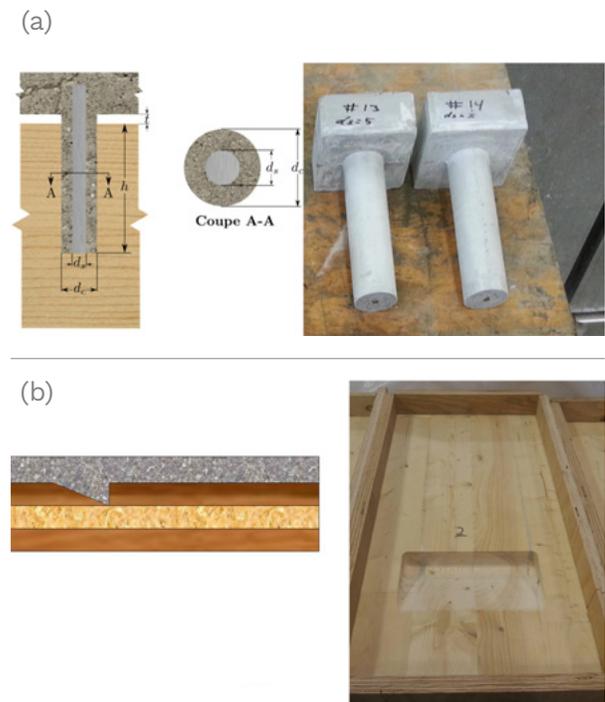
Connecteurs développés au CIRCERB : (a) connecteur en BFUP avec tige d'acier pour plancher BLC-béton; (b) connexion par entaille pour plancher en CLT-béton.
